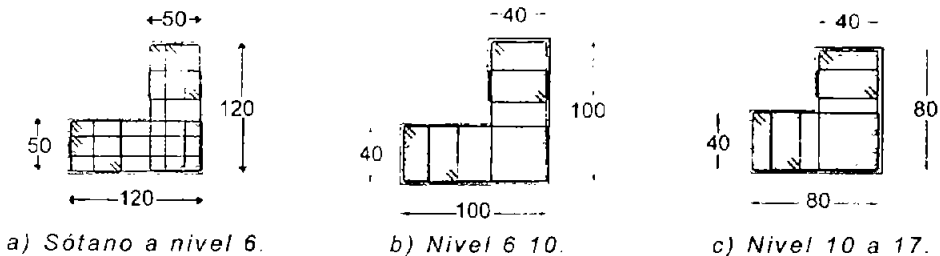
Columna C5, dimensiones cm (Planos de plantas tipo, 2001).
